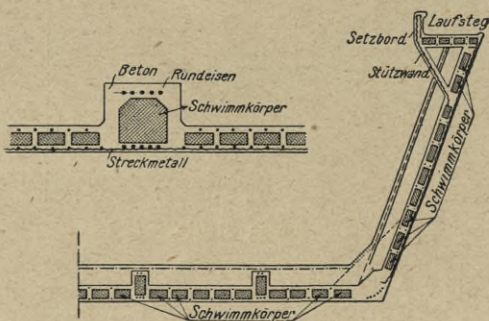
Eisenbetonschiff von 22 m Länge, Bauweise Rüdiger.
